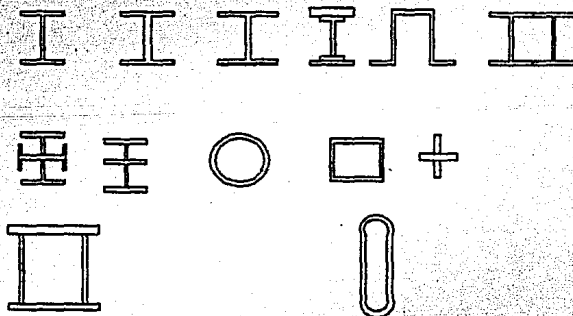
SECCIONES PARA COLUMNAS DE ACERO
